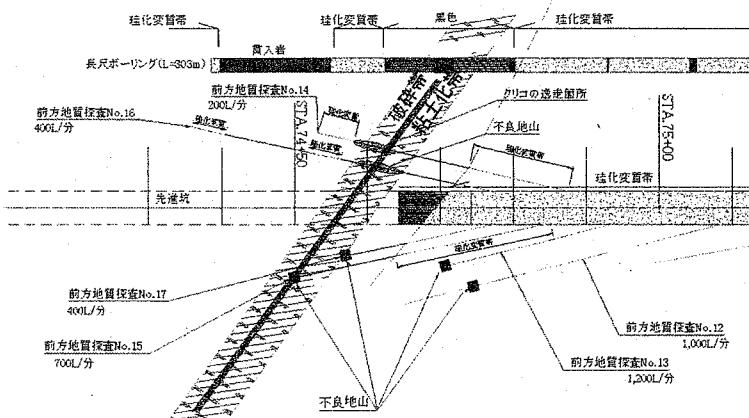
長尺鋼管先受け施工位置付近の想定地質平面図
